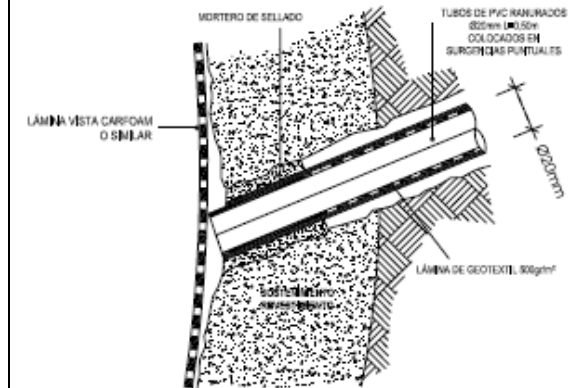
Detalle Tubo PVC Ranurado en Surgencias Puntuales de Agua
